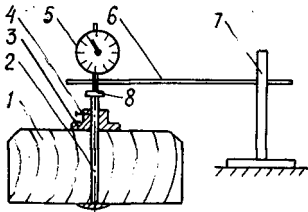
Схема пустотомера: 1 — шпала; 2 — шток со сферическим диском; 3 — муфта; 4 — установочный винт; 5 — индикатор часового типа; 6 — держатель индикатора; 7 — штатив; 8 — плоский диск
